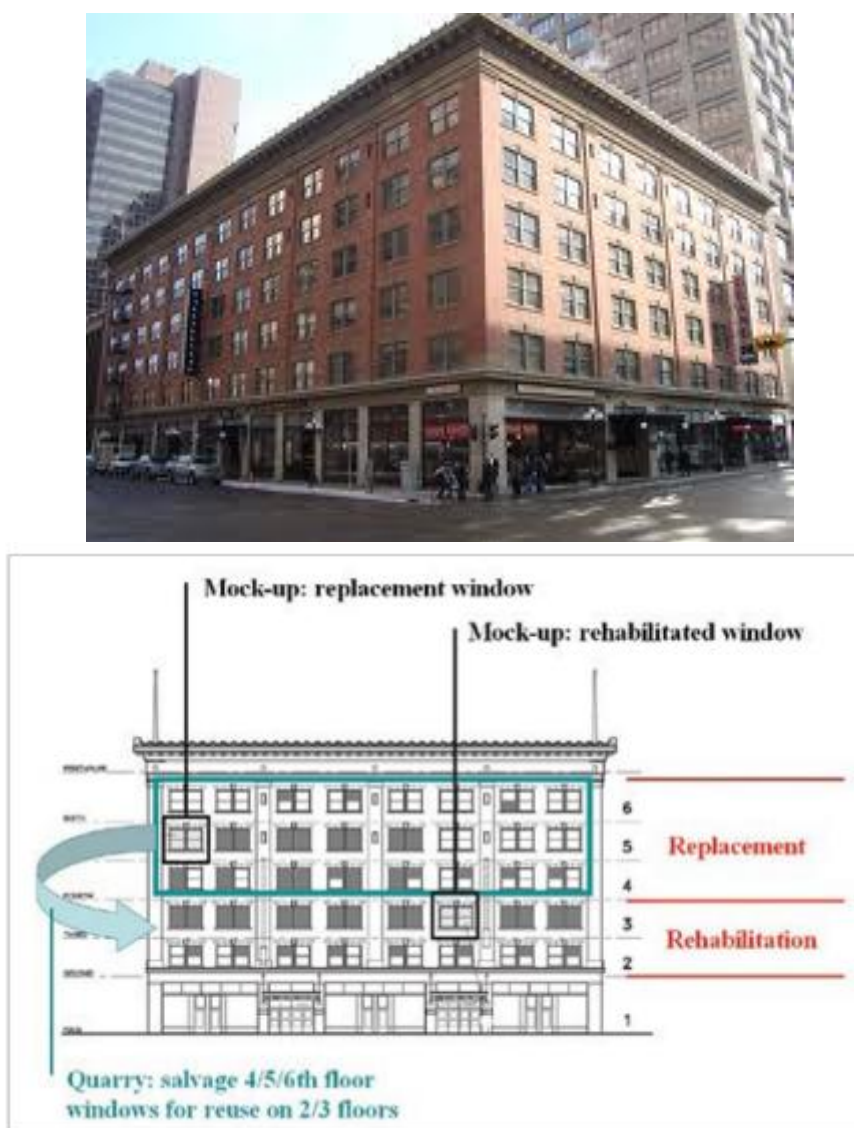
FIGURA – Reabilitação do Lougheed Building, Calgary, Canadá.
